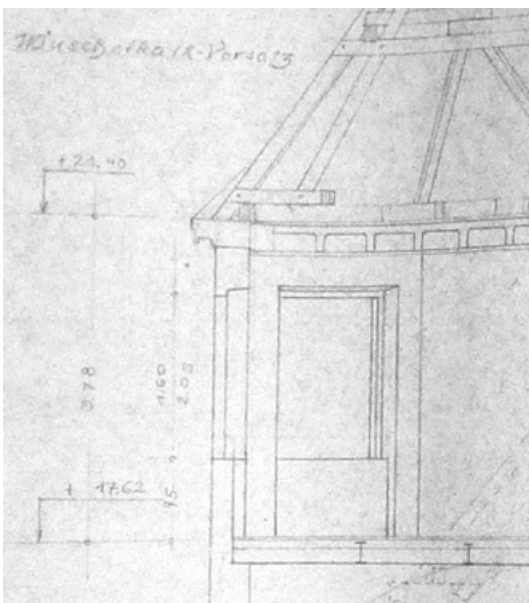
Teilschnitt mit Darstellung einer Rippendecke unter dem Dachtragwerk (Bauref. Akt-Nr. 177).
